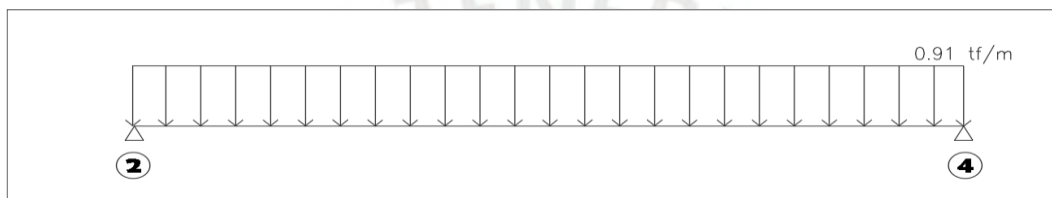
Cargas últimas de la Viga chata (L=3.35 m)
